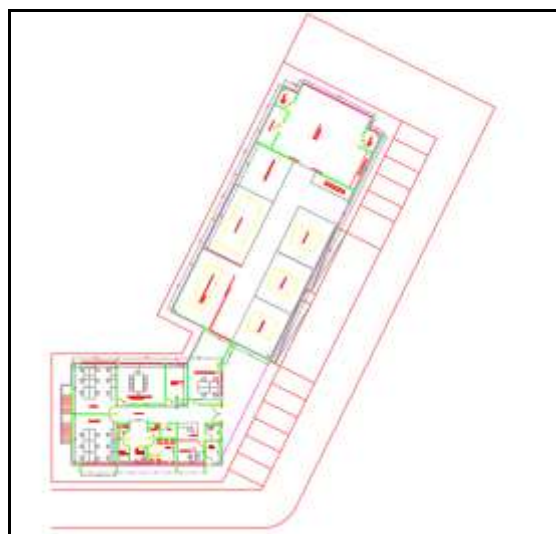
Planteamiento arquitectónico, distribución Centro de Innovación.
